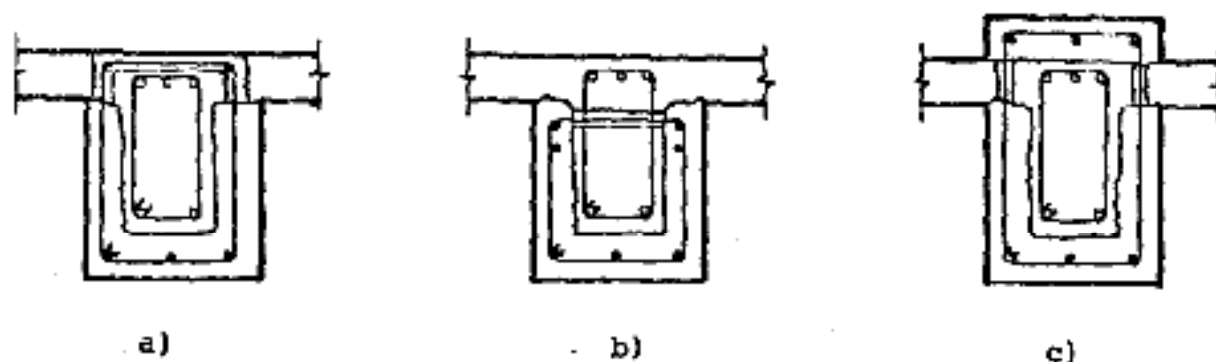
Encamisado por flexión y cortante de vigas con concreto reforzado (ref. 1)
